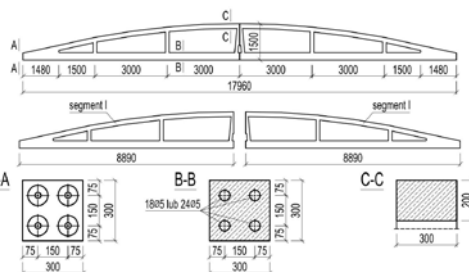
Koncepcja dźwigara typu SDK na przykładzie elementu o rozpiętości 30 m
